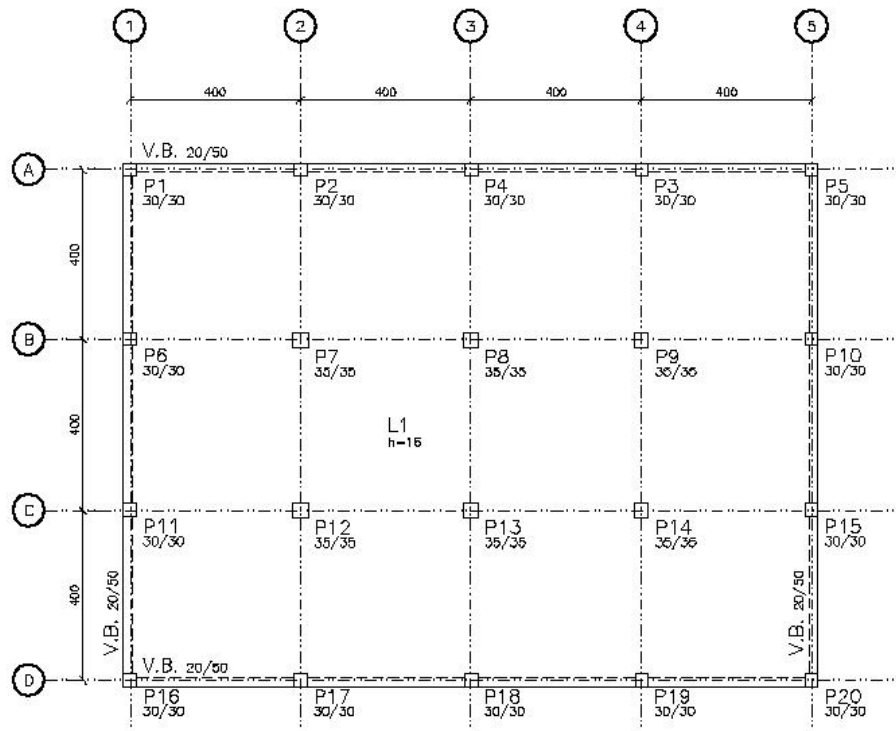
Planta do pavimento em malha quadrada (tipo B)
